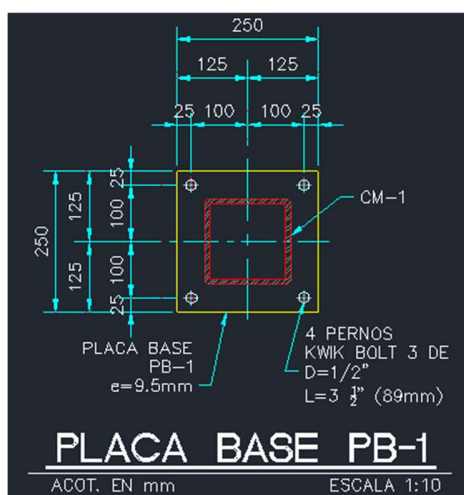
Detalle de placa base de estructura de elevador. Elaborado por el autor.
